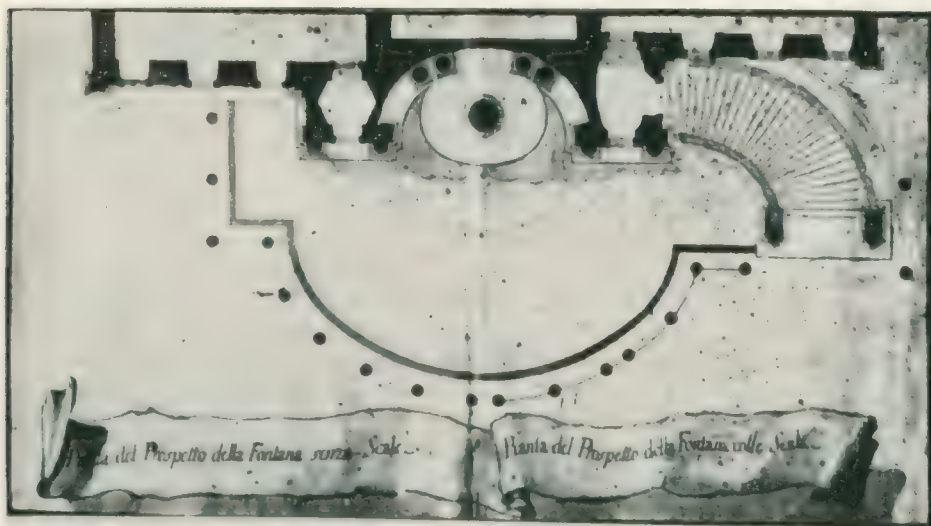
Luigi Vanvitelli, Progetto «B» per la Fontana di Trevi. Prospetto e Pianta. (Gabinetto Nazionale delle Stampe).
